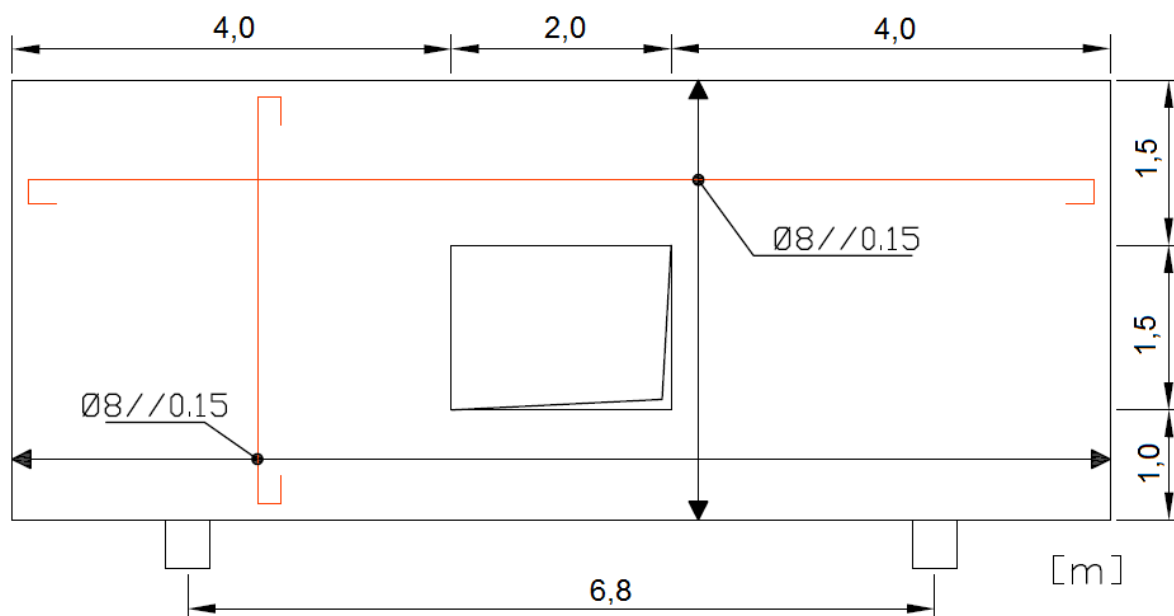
Desenho das armaduras longitudinais na face anterior (inferior).
